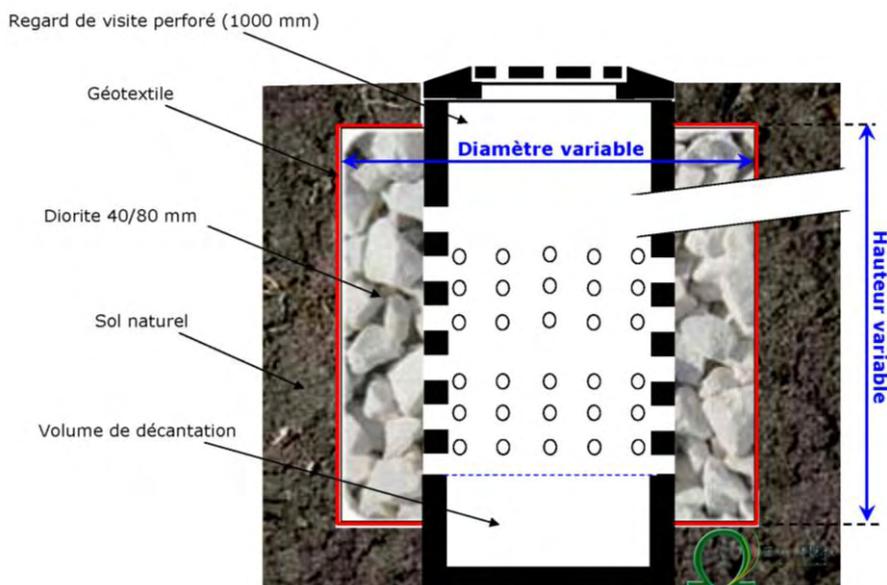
coupe de principe d'un puits d'infiltration pour les eaux de toitures
